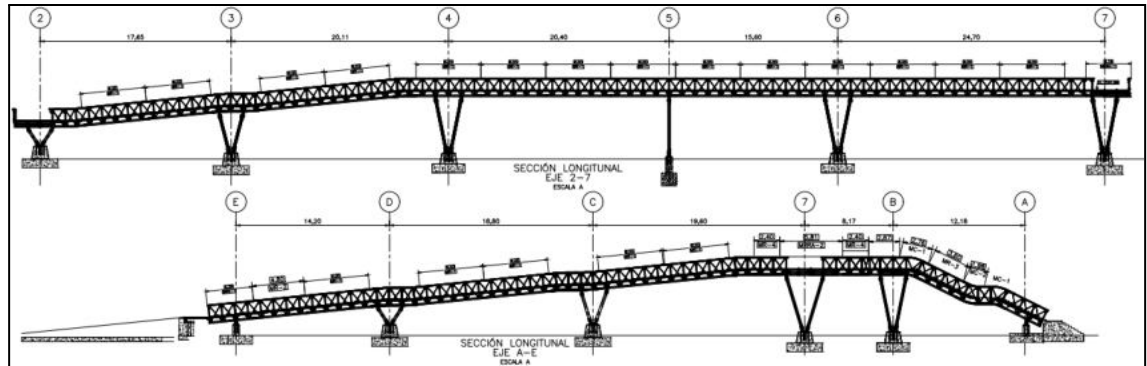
Planta y perfil longitudinal de la pasarela metálica sobre la Av. Boyacá
